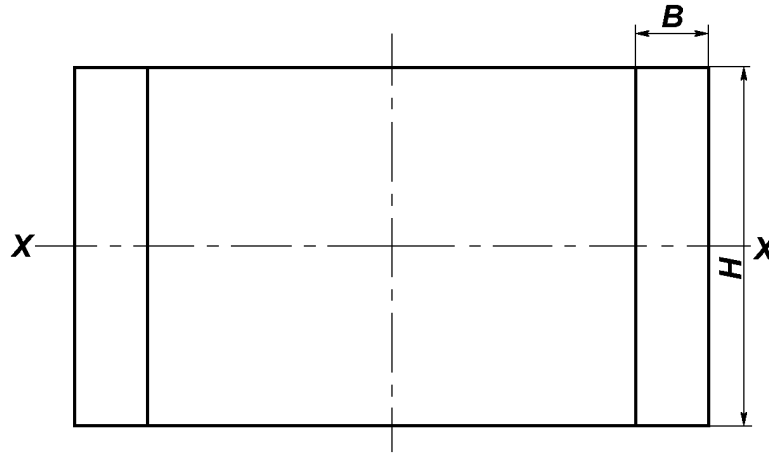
Определение поперечного сечения балки в поперечной плоскости
